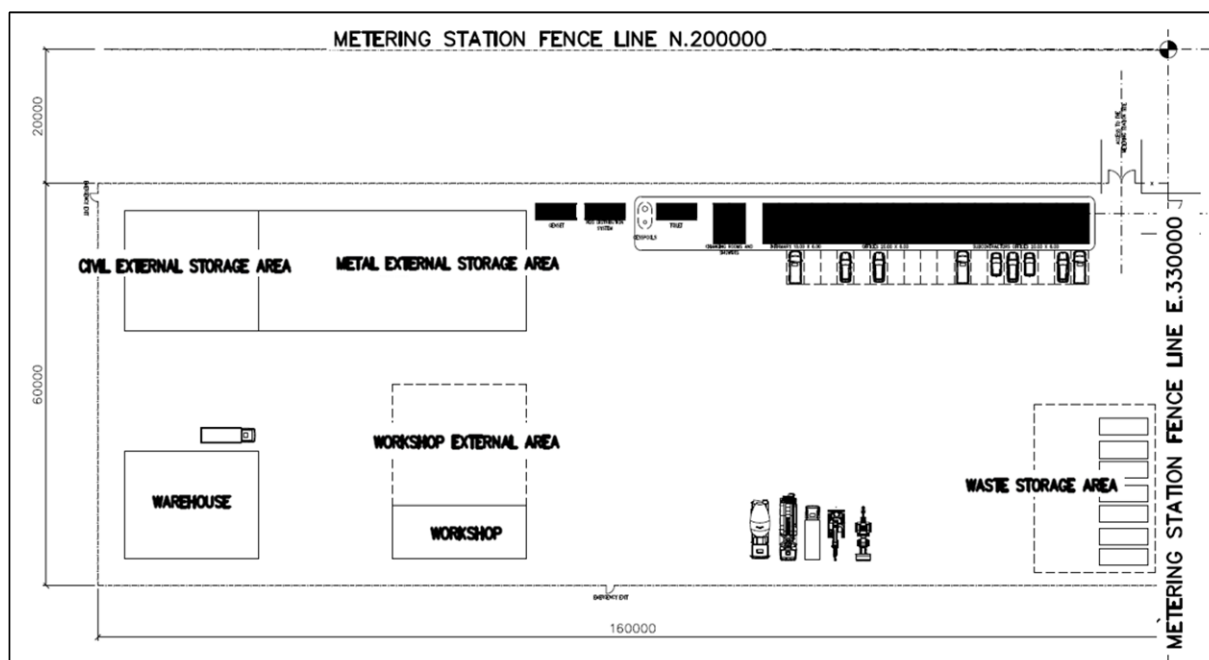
Lay-Out Area di Cantiere adiacente alla Stazione di Misura di Otranto
